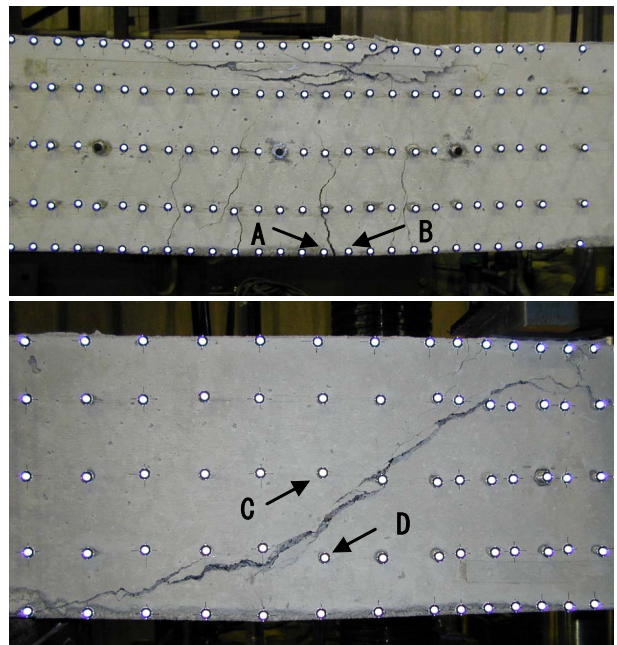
破壊状況 (上 : B-1, 下 : S-1)
